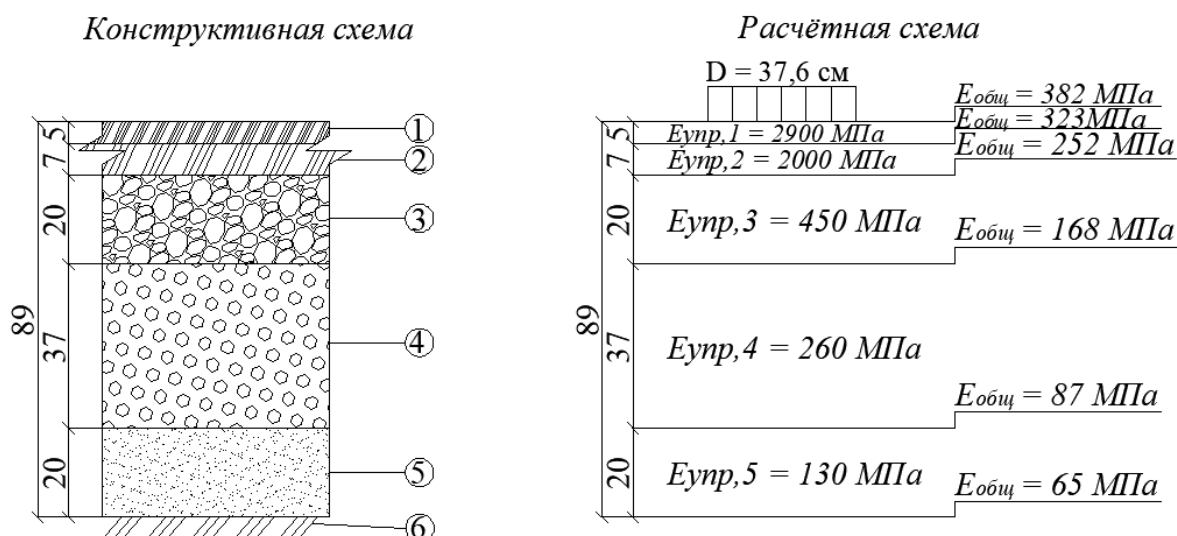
Конструктивная и расчетная схемы дорожной конструкции с покрытием из теплого модифицированного асфальтобетона
